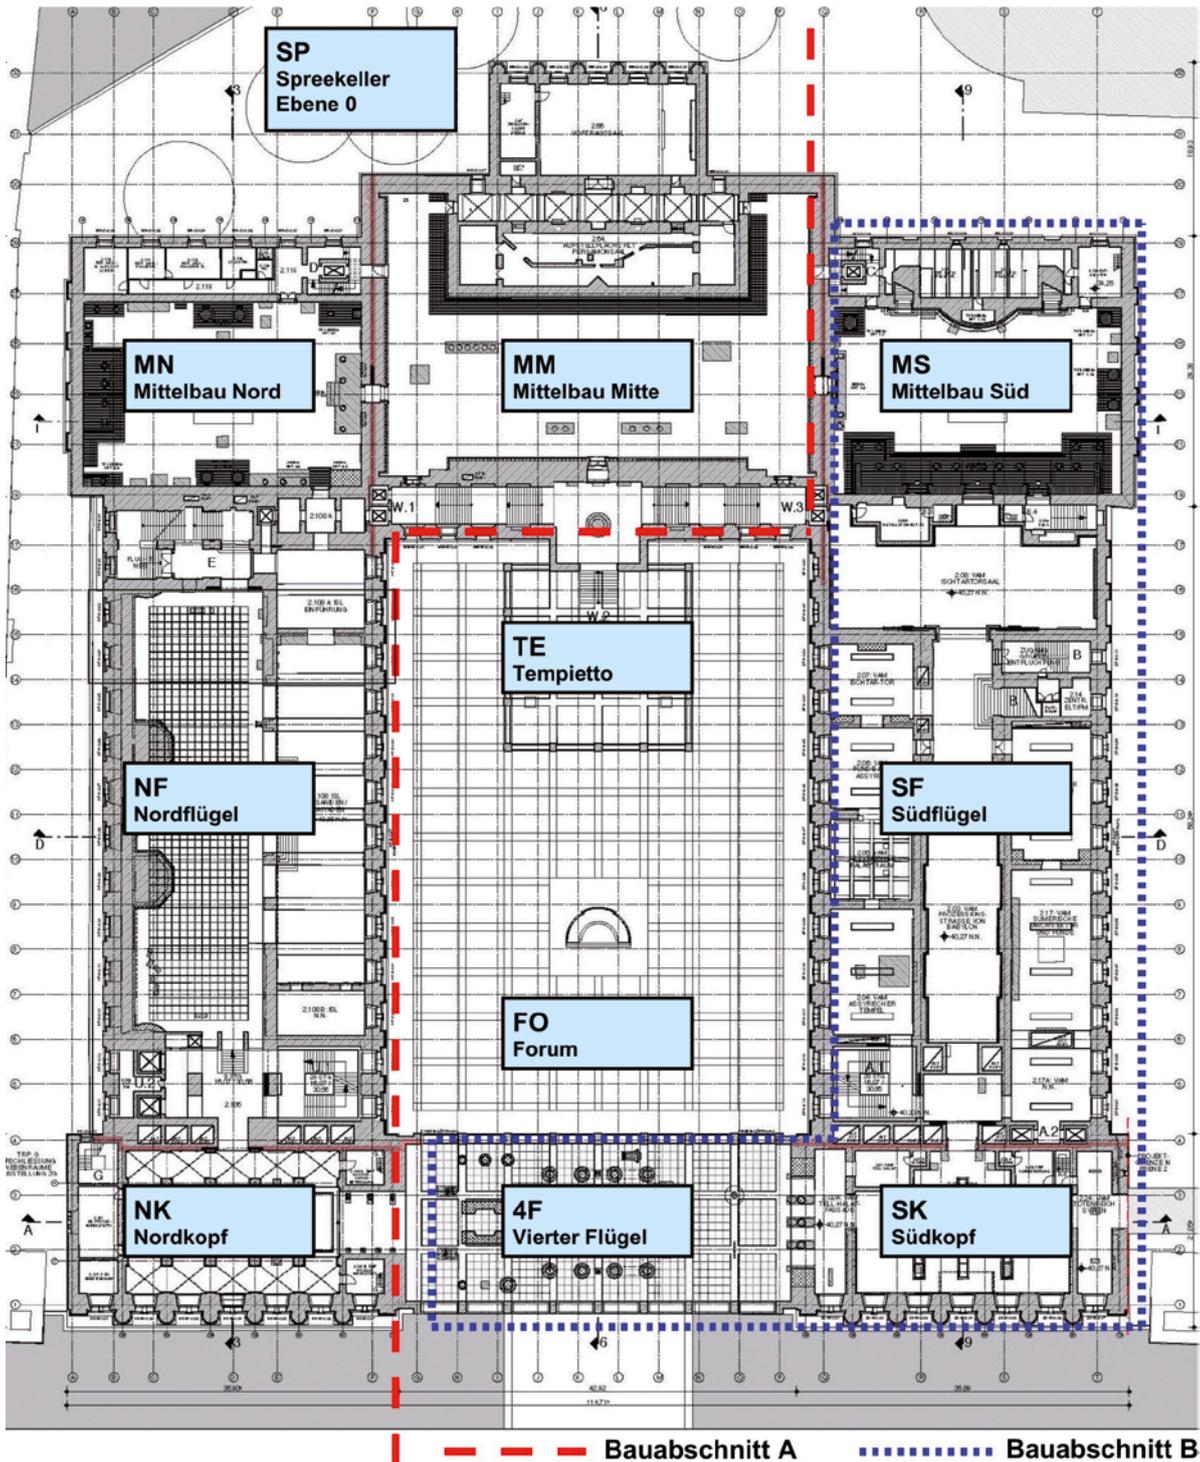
Bauabschnitte der Grundinstandsetzung/Ergänzung mit Bauteilen
